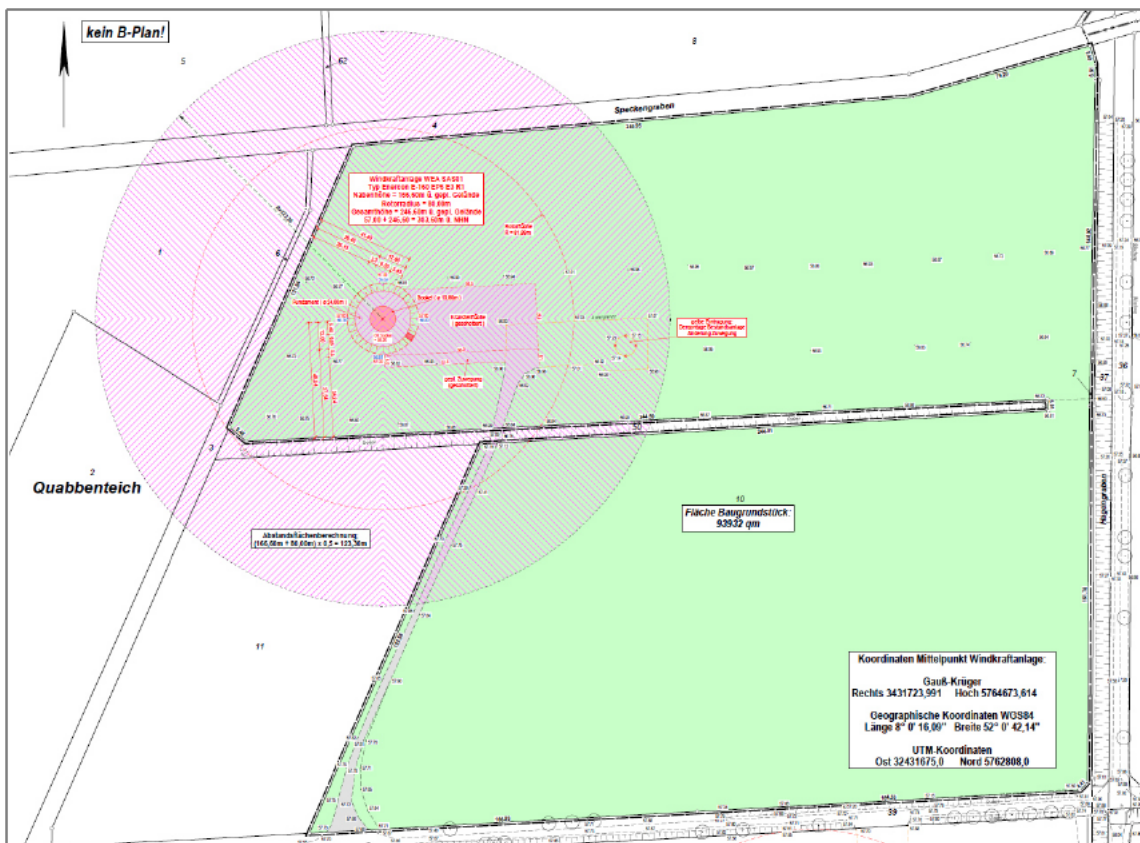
Ausschnitt aus dem Amtlichen Lageplan zum Bauantrag für die WEA SAS 01 (VERMESSUNGSBÜRO SOMMERHOFF; Stand: 19.10.2023).
